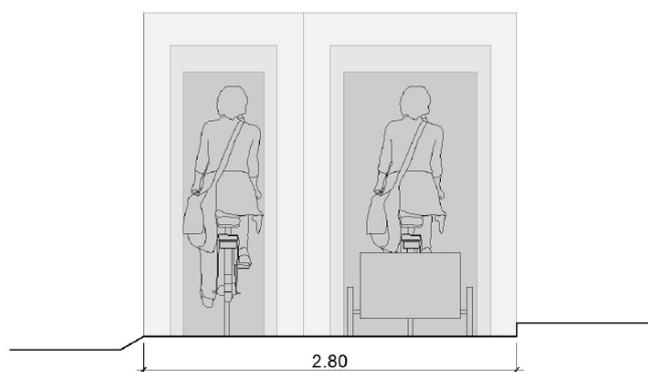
Dépassement sur une piste cyclable unidirectionnelle insérée entre la route et le trottoir
